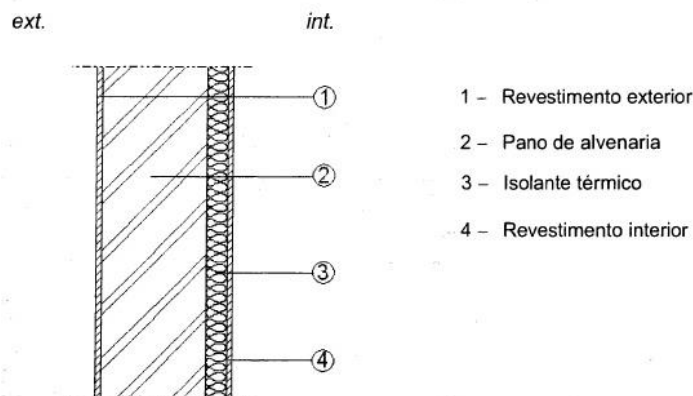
Pormenor construtivo de isolamento pelo interior
